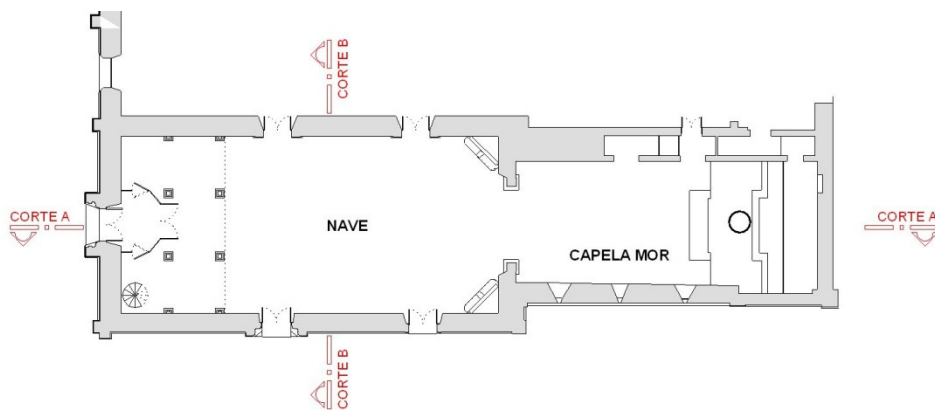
c: Igreja da Ordem III de São Francisco das Chagas – croqui: planta da nave e presbitério.
